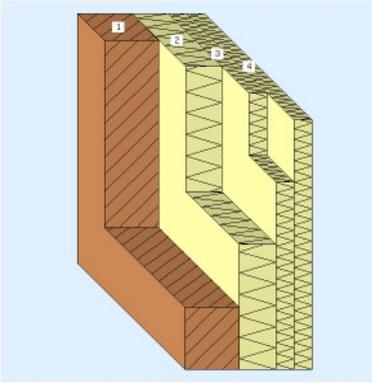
Brettschichtholz wand mit Holzspanbeton und Hanffasermattung [33]
